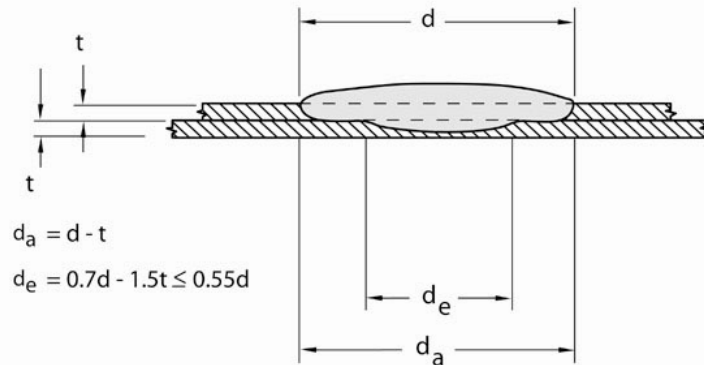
Soldadura de tapón — Lámina a lámina
